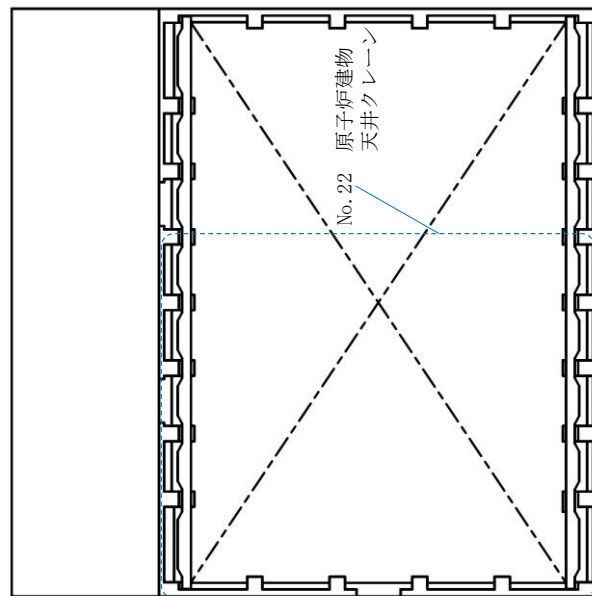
(2) 影響検討対象設備の概略配置図 (平面図 EL. 51.700m)
